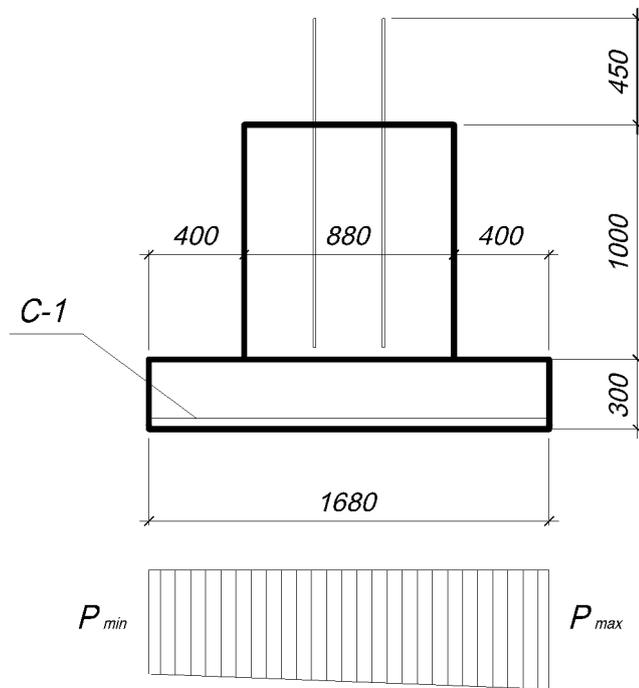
До визначення перерізу арматури плитної частини фундаменту
